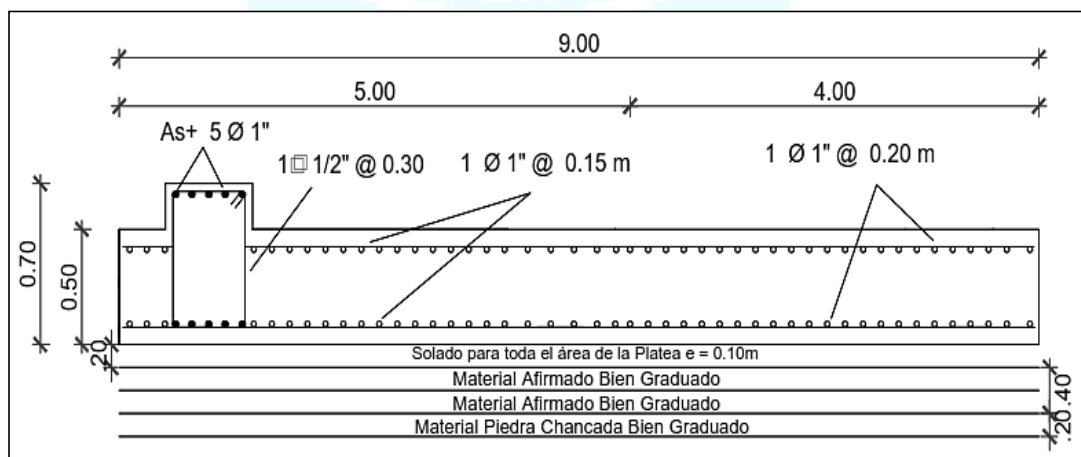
Detalle de refuerzo en viga y platea de cimentación
